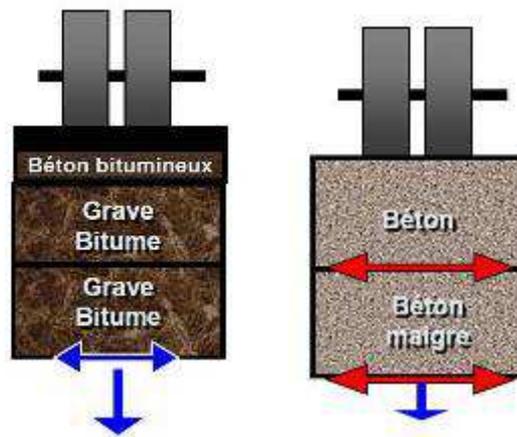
Plans en coupe d'une structure bitumineuse et d'une structure béton
